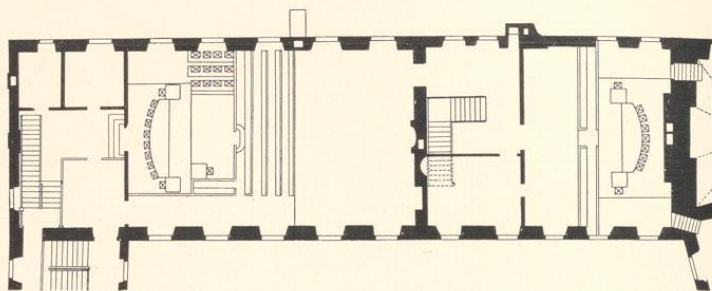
Grundriß des Obergeschosses, Entwurf von 1813
